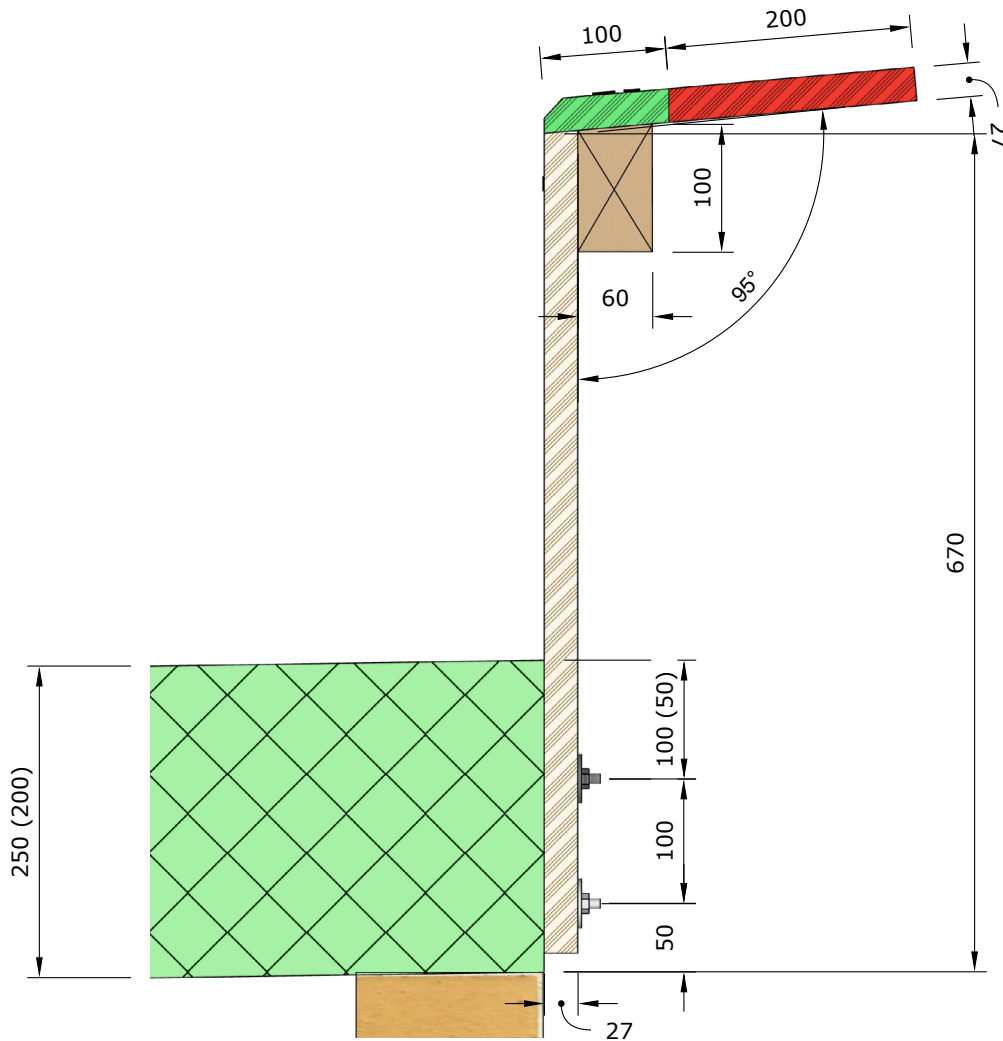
Schnitt durch Dachrandkonstruktion beschränkt betretbar, Masse in mm. Grafik: Im grünen Bereich bis 100 kg betretbar.
